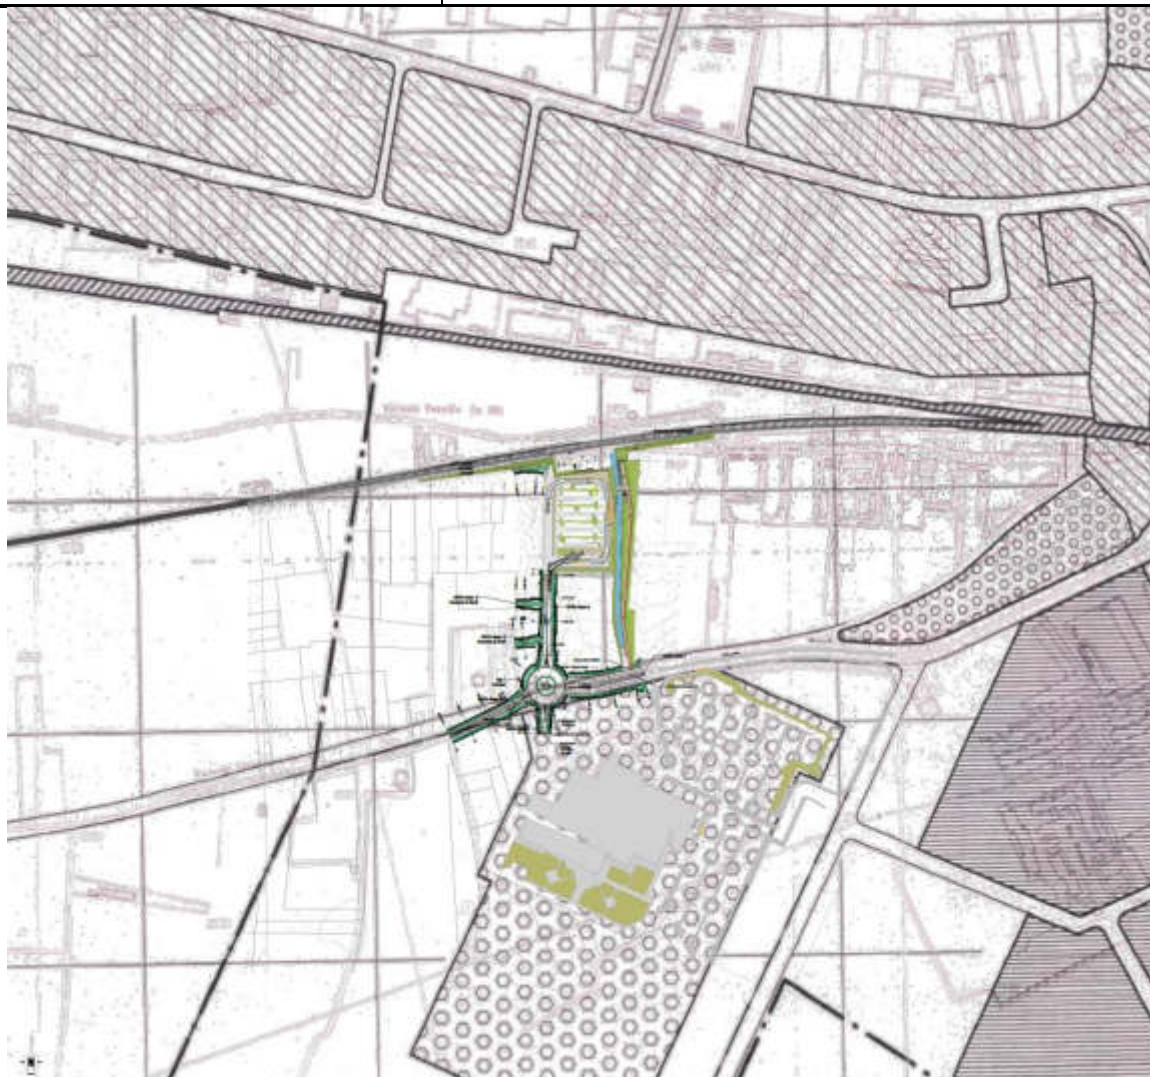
Sovrapposizione dello stralcio di PRG con il progetto in oggetto
